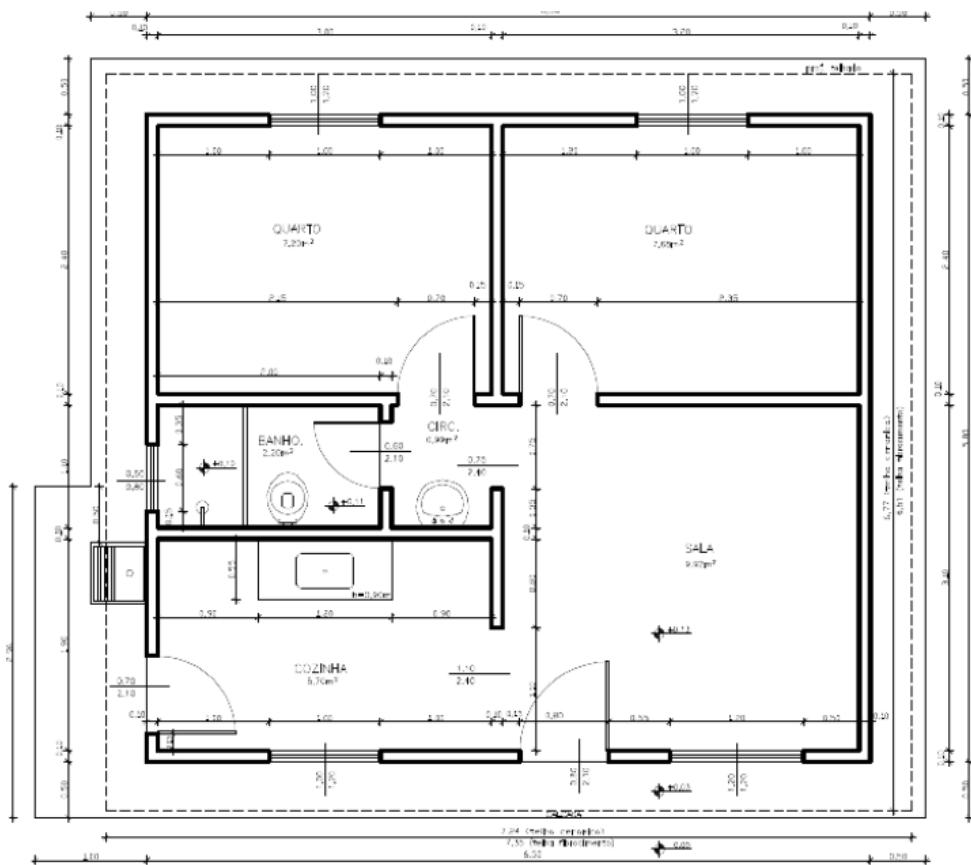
Tipologia da planta baixa de casa térrea – Fonte: Cartilha MCMV (2014, p.6).
